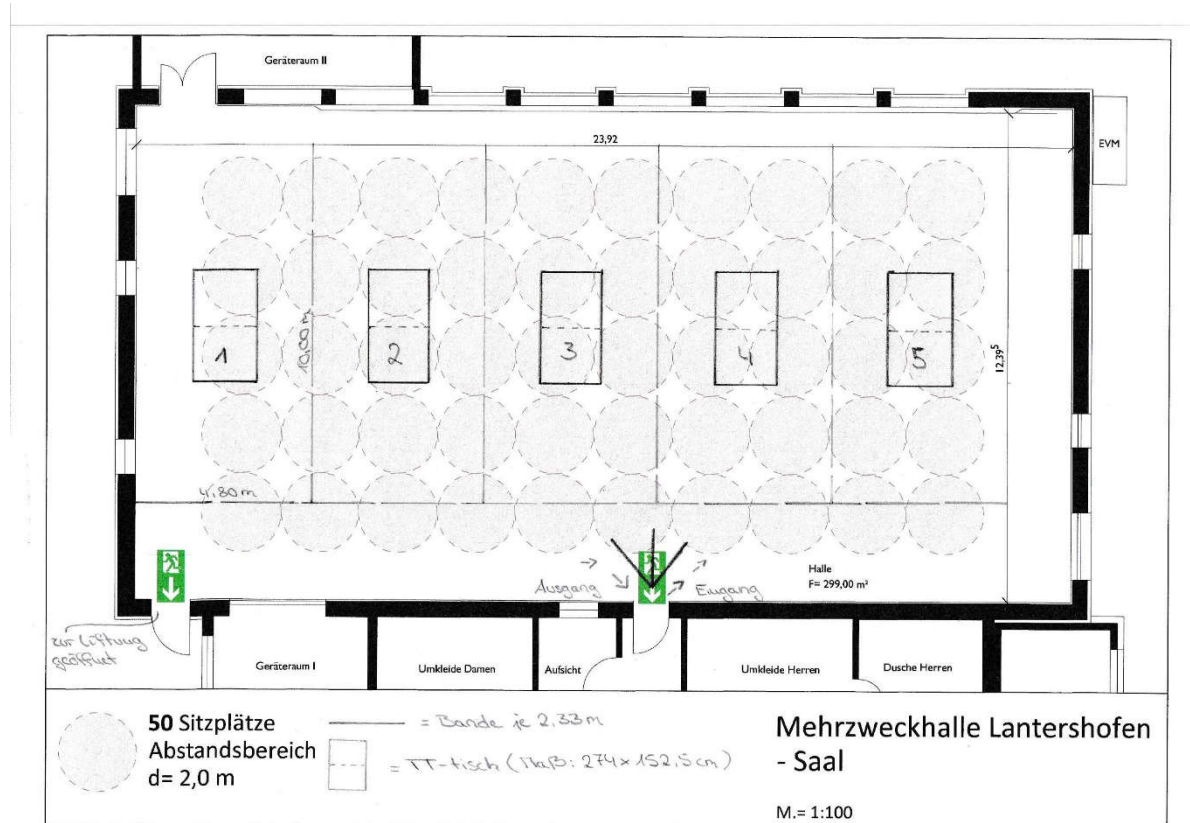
Lageplan mit Tischaufbau und Lüftungsmaßnahmen in Lantershofen.
